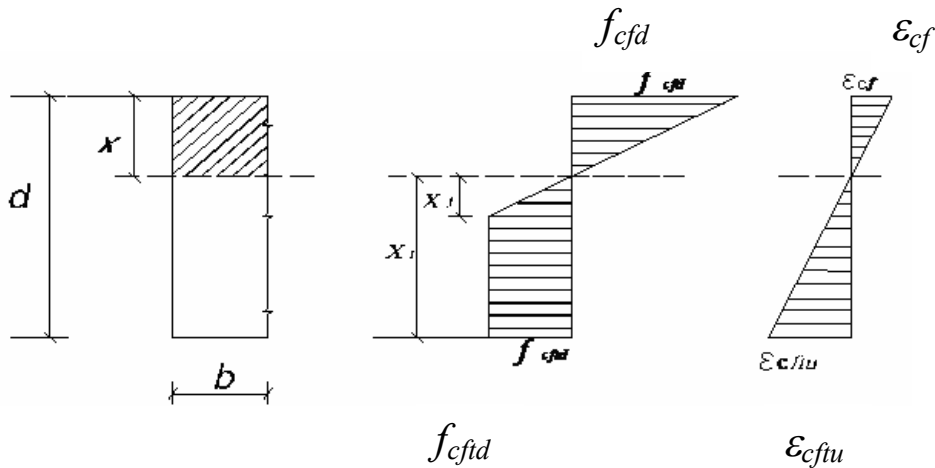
Расчетная схема сталефибробетонного элемента прямоугольного сечения
